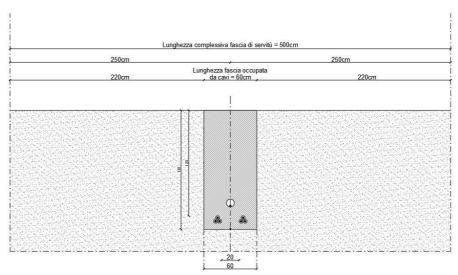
Sezione tipo scavo e fasce di rispetto per servitù di elettrodotto su terreni agricoli privati
